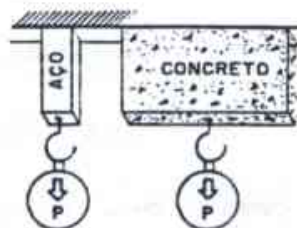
Ilustração da seção transversal da peça de aço equivalente a 1/20 da peça de concreto quando submetidas a uma mesma carga. (FONTE – Fakury,s.ref. p. 11).
